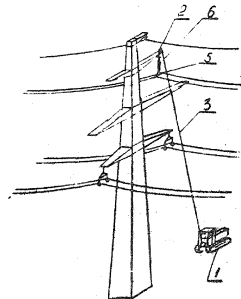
Перекладка проводов верхней траверсы с опусканием на среднюю траверсу опоры.
